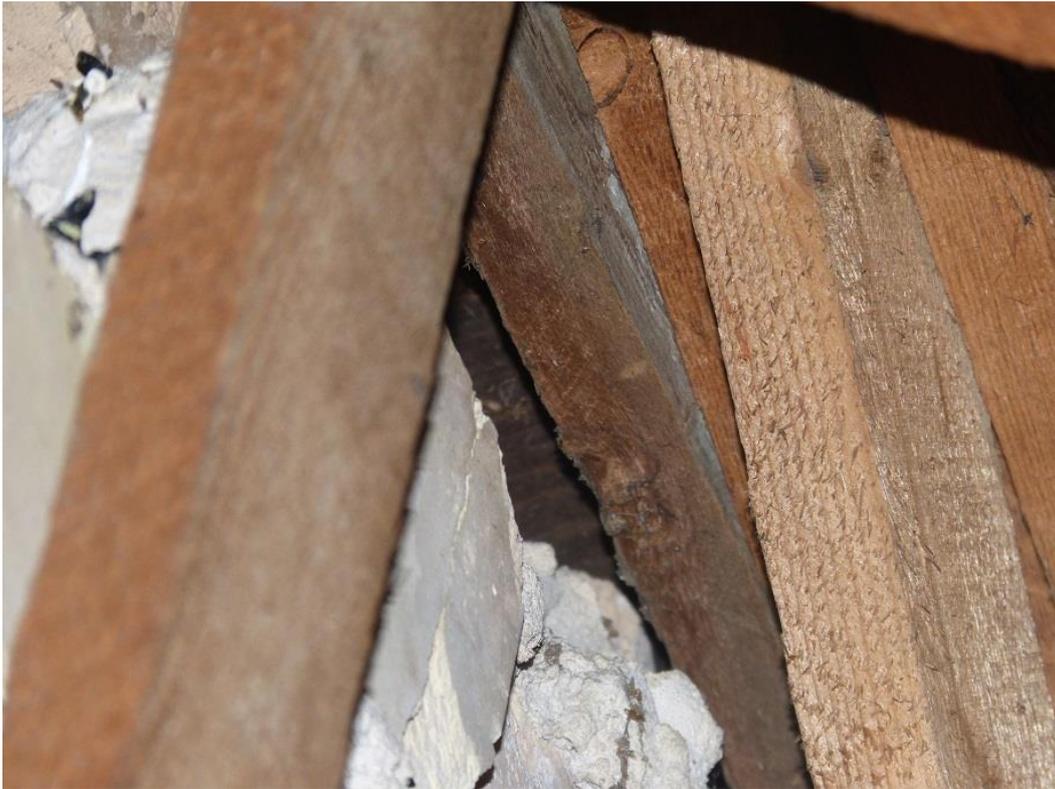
Untersuchung Hohlraum zwischen Holzständerwerk und Giebel im Dachgeschoss
